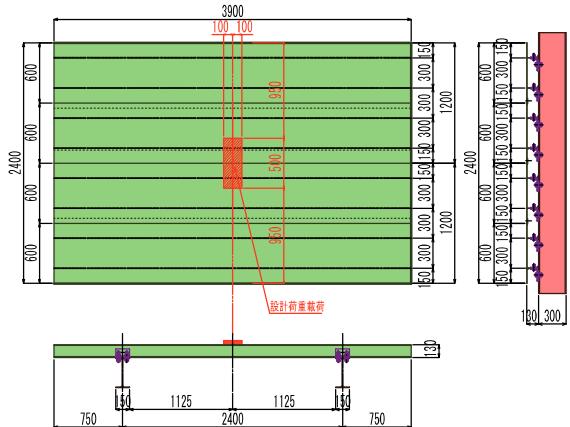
鉛直力載荷試験（分布荷重）の供試体概要図
